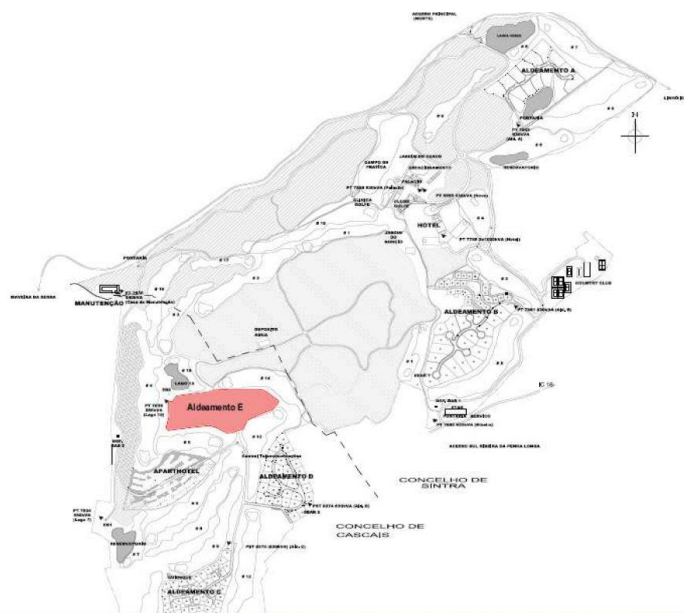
Localização do aldeamento turístico “E” no conjunto turístico da Penha Longa (Planta extraída do PIP). (Fonte: Figura 1 - Nota Técnica - Anexo 2, Aditamento)
